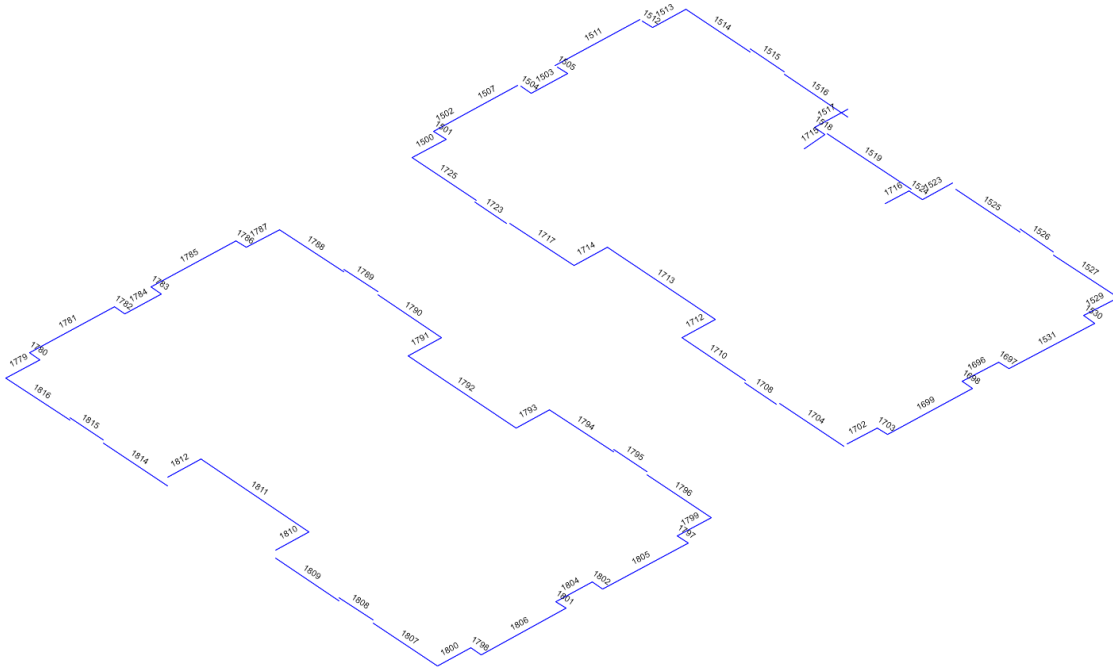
Nomes 'Frames' - Vigas platibanda
